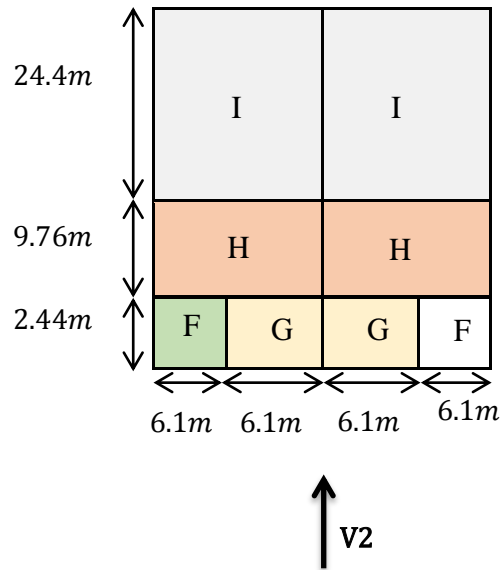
Vue en plan des zones de pression sur la toiture suivant le pignon.
